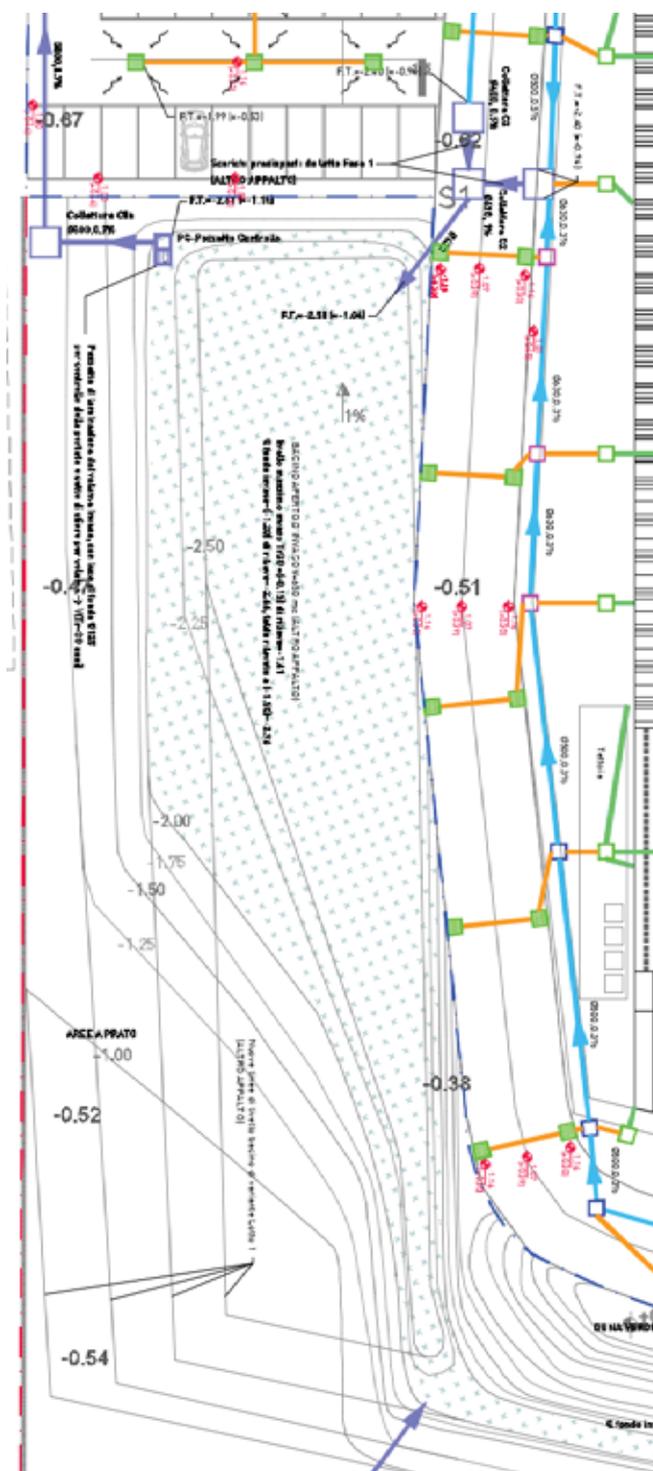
Bacino di laminazione aperto di progetto Fase 1, con predisposizione scarichi da Lotto Fase 2
